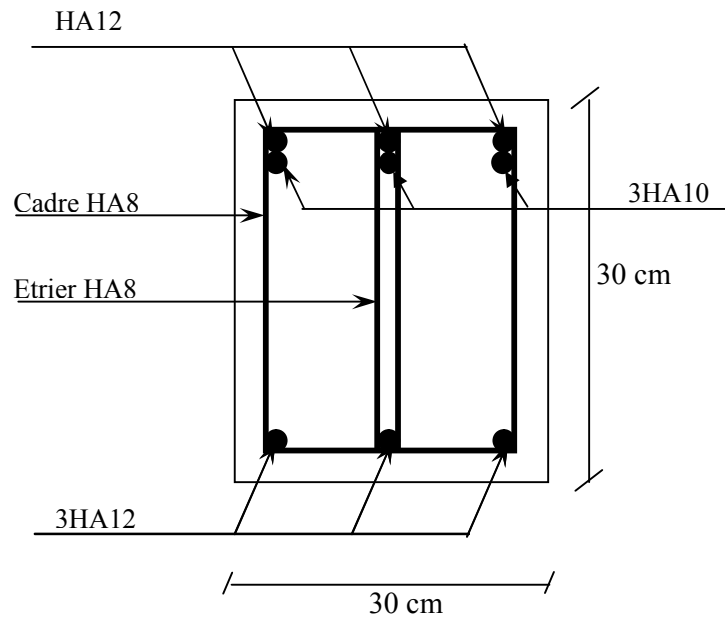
Schéma de ferrailage de la poutre de chaînage
